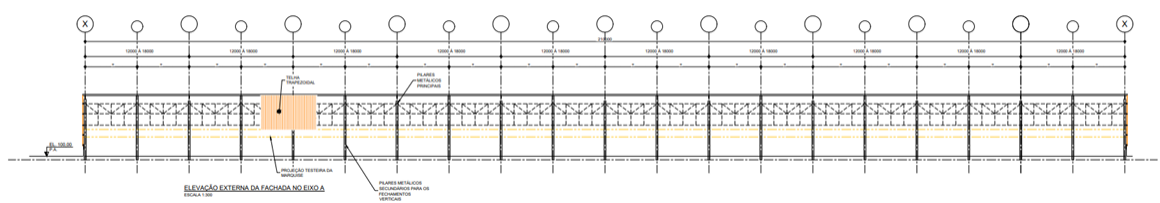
ELEVÇÃO EXTERNA DA FACHADA NO EIXO A
